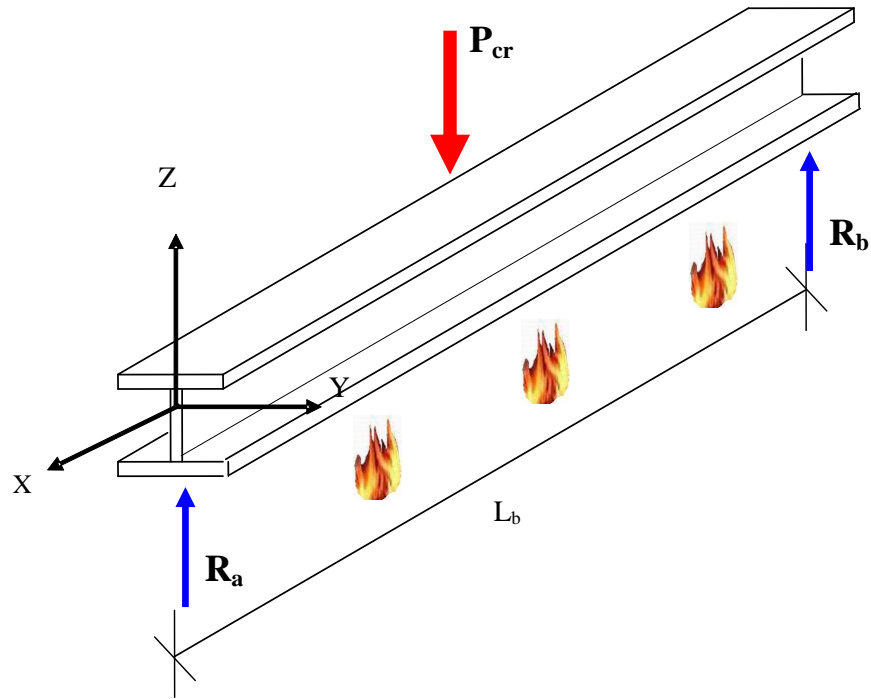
Viga em perfil metálico I submetida à flexão pura
